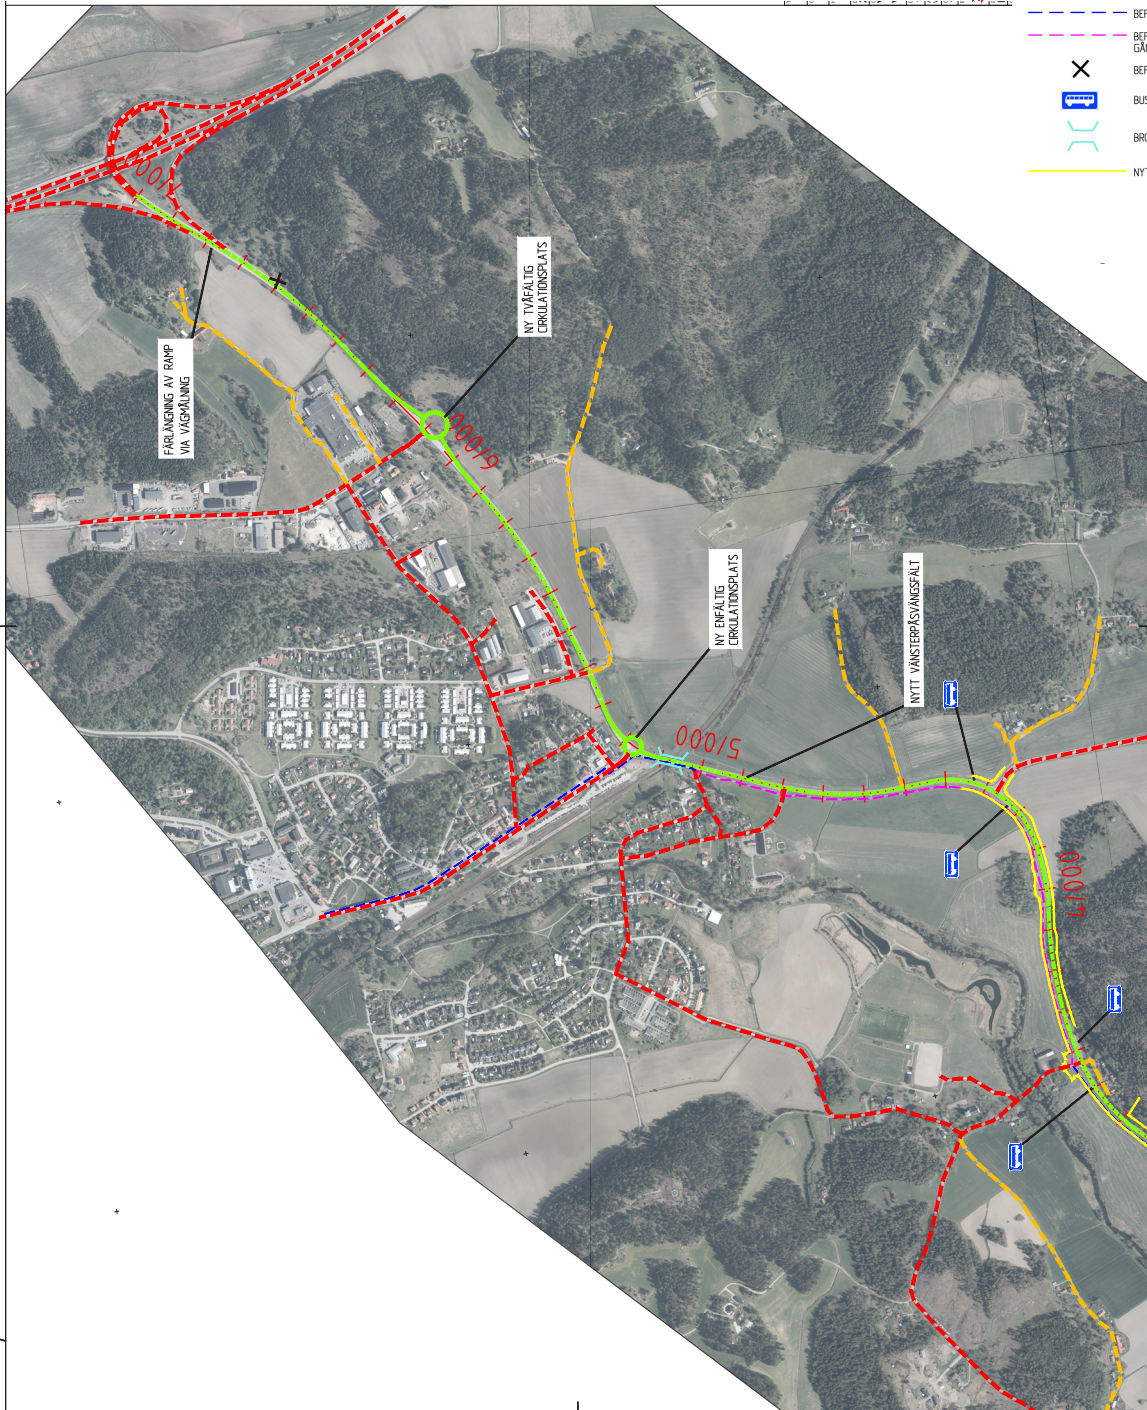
Översiktsplan med föreslagna åtgärder utmed sträckan.
